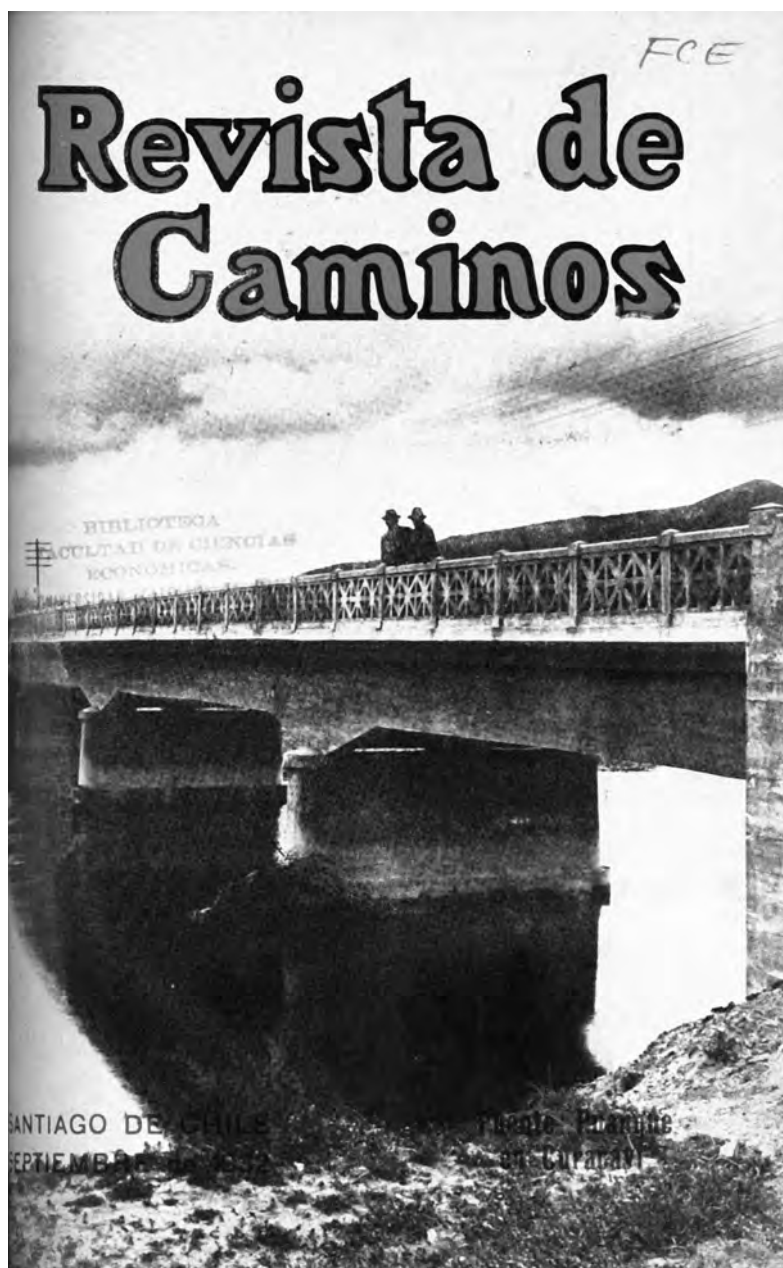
Puente de hormigón armado sobre el estero Puangue en Curacaví, *Revista de Caminos*, septiembre de 1932.
